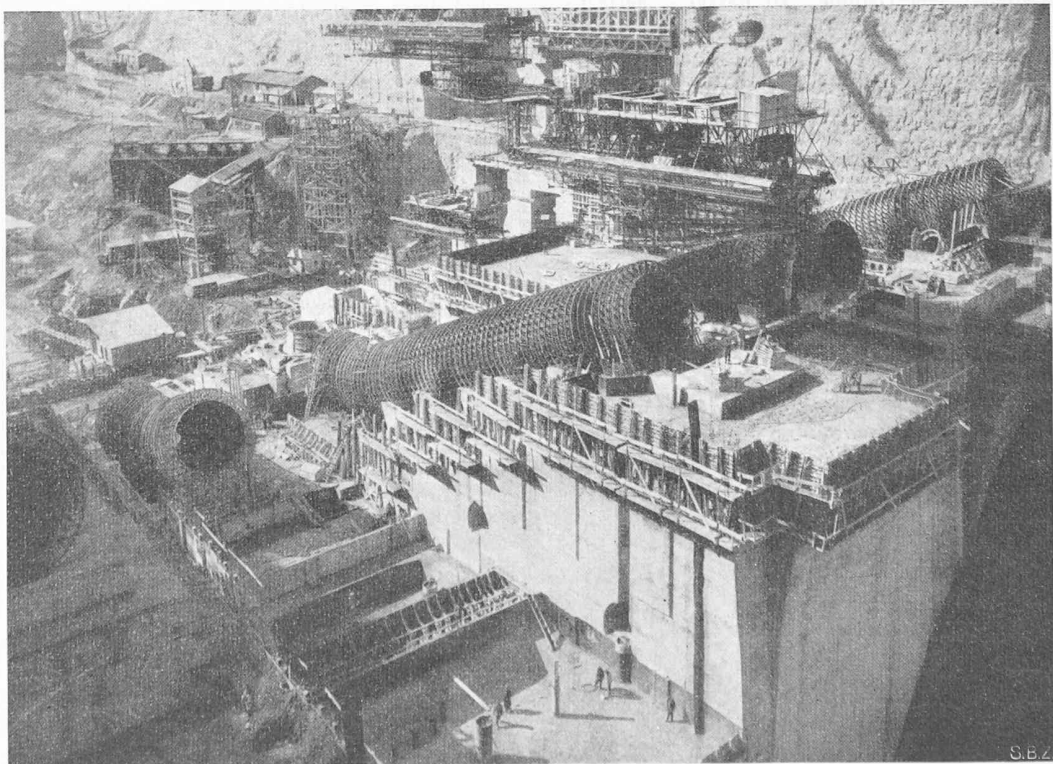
Staumauer mit Druckrohrleitungen im Bau, am 15. März 1946
